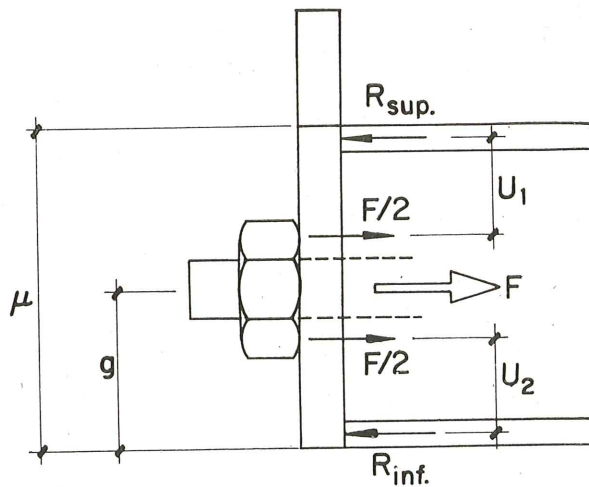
Esquema de esfuerzos, en placa de anclaje.
